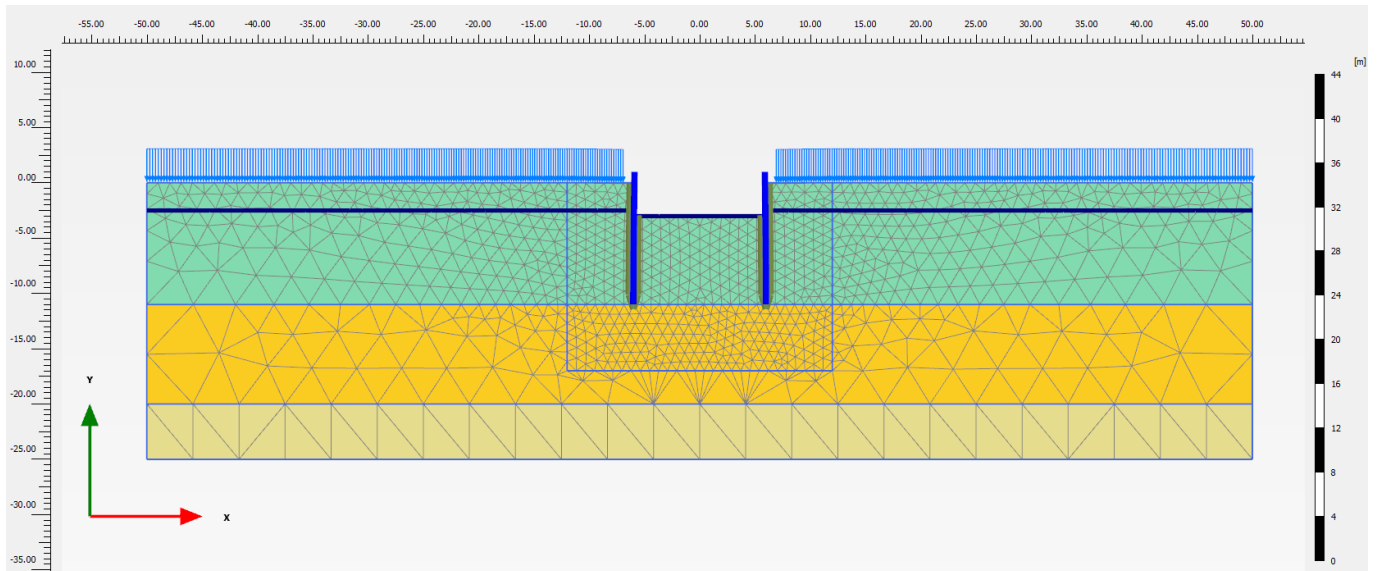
Sezione 1, Scavo massimo e applicazioni dei carichi
